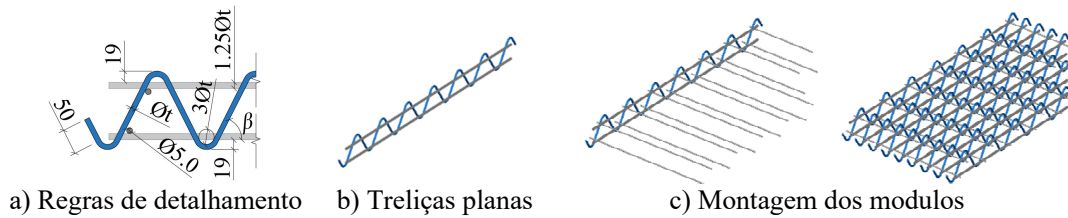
Detalhamento e montagem dos estribos treliçados pré-fabricados.
